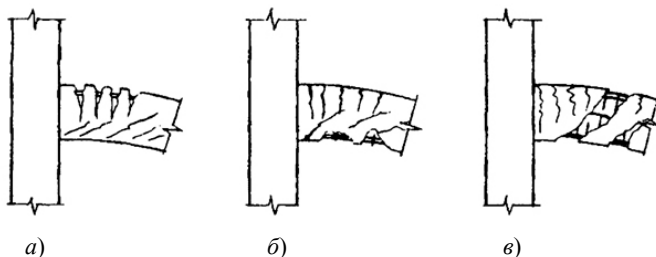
Разрушение железобетонной балки от смещения опоры:
